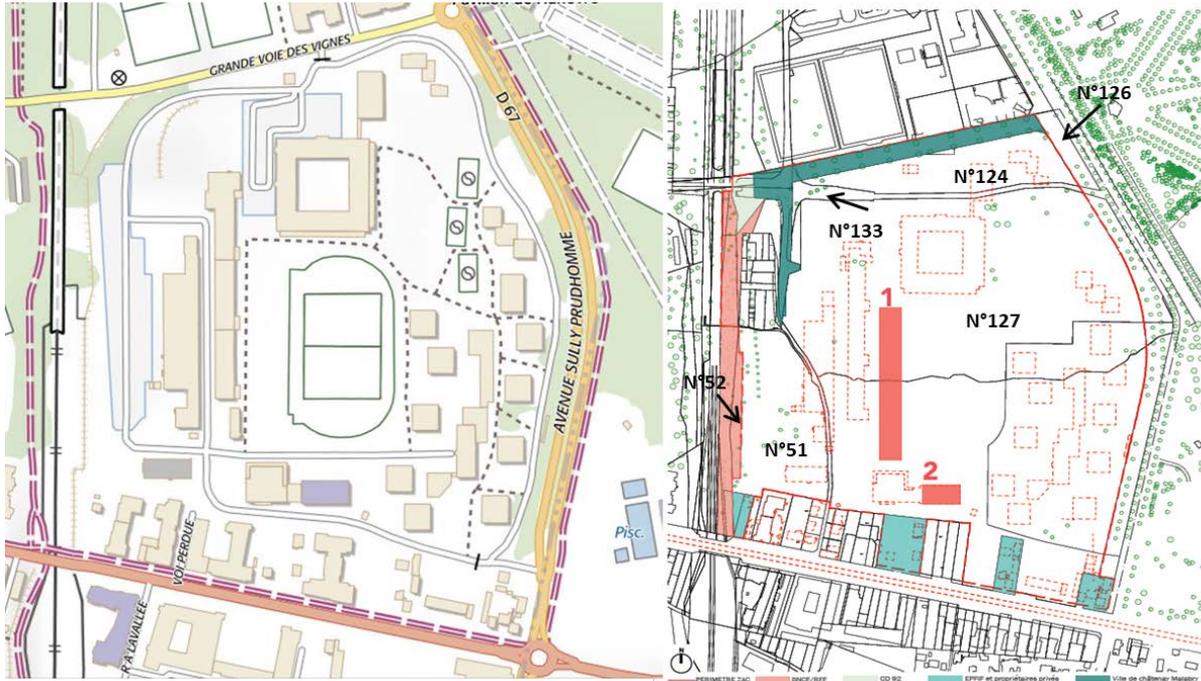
Site d'implantation des chantiers de forage et parcelles cadastrales
